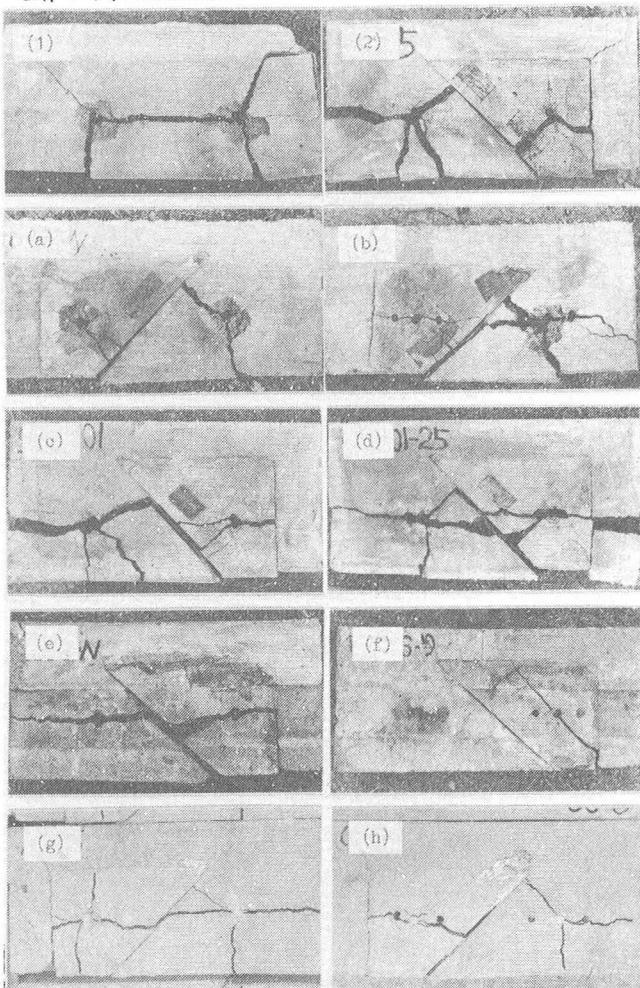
コンクリートモルタルの破碎と破壊面の形成。
